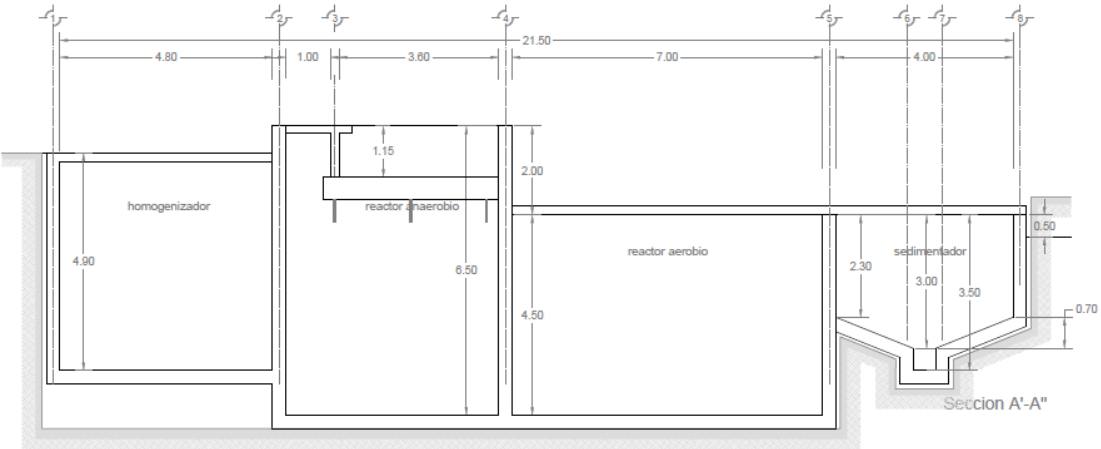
Plano arquitectónico de PTAR ZUP (Imbrium, 2013)
